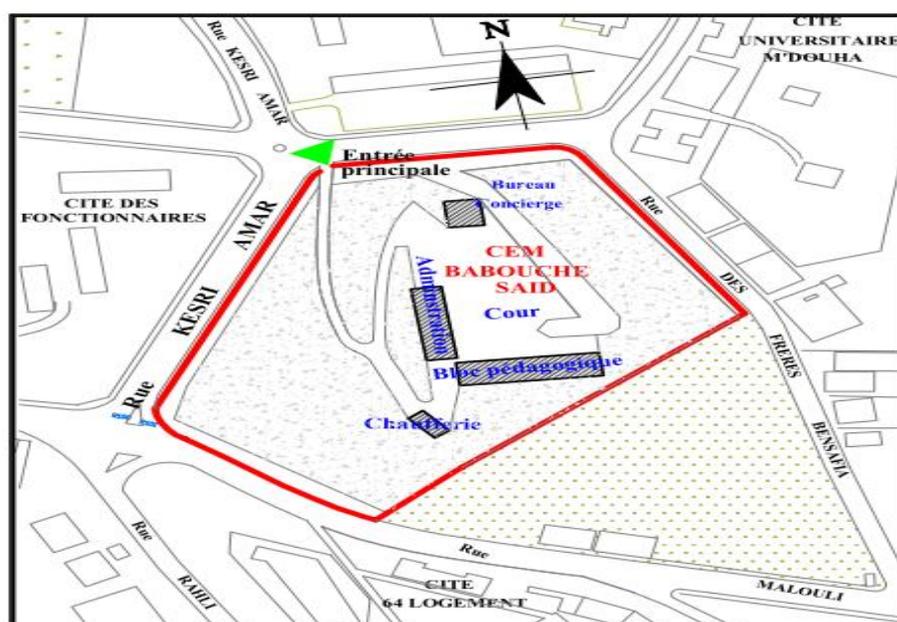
Plan de masse du CEM Babouche Saïd.
